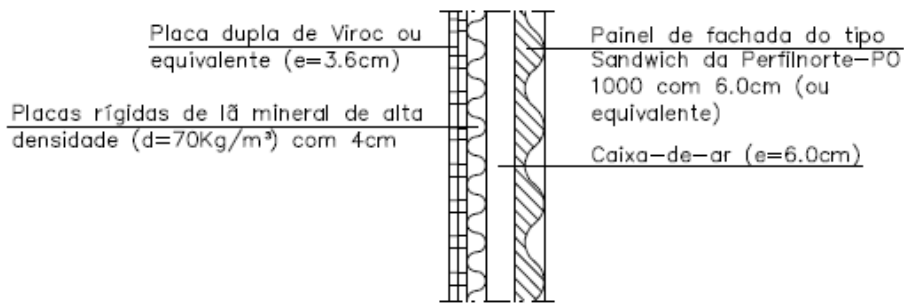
Pormenor construtivo da parede interior de separação das frações com a CVC (Projeto de CT)
